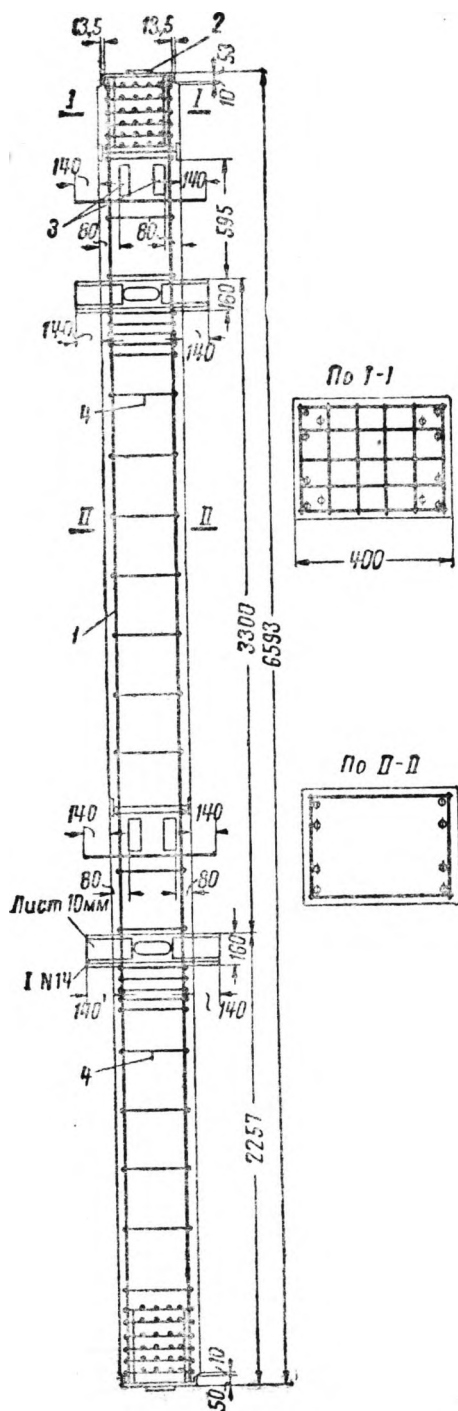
Колонна каркаса многоэтажного здания (из нормалей для московских заводов железобетонных изделий)
